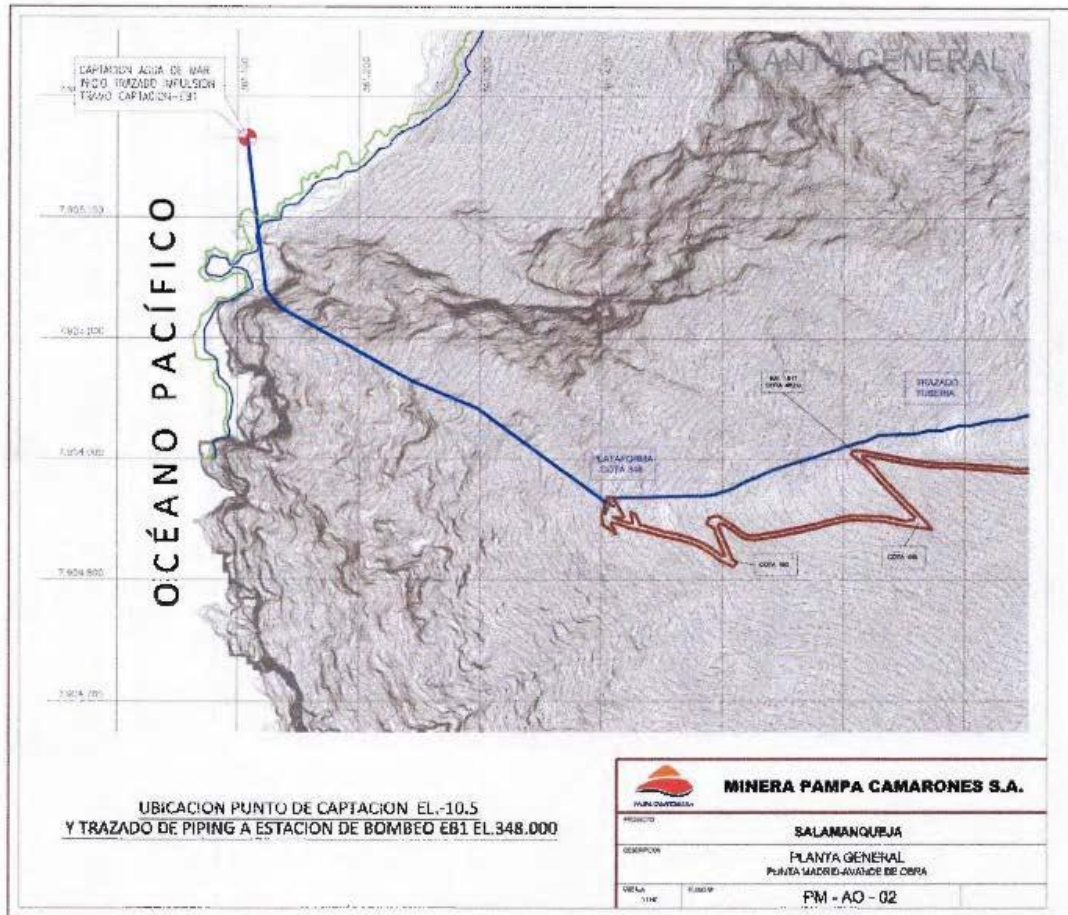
Planta General Proyecto SIAM desde Sector Captación a EB1
